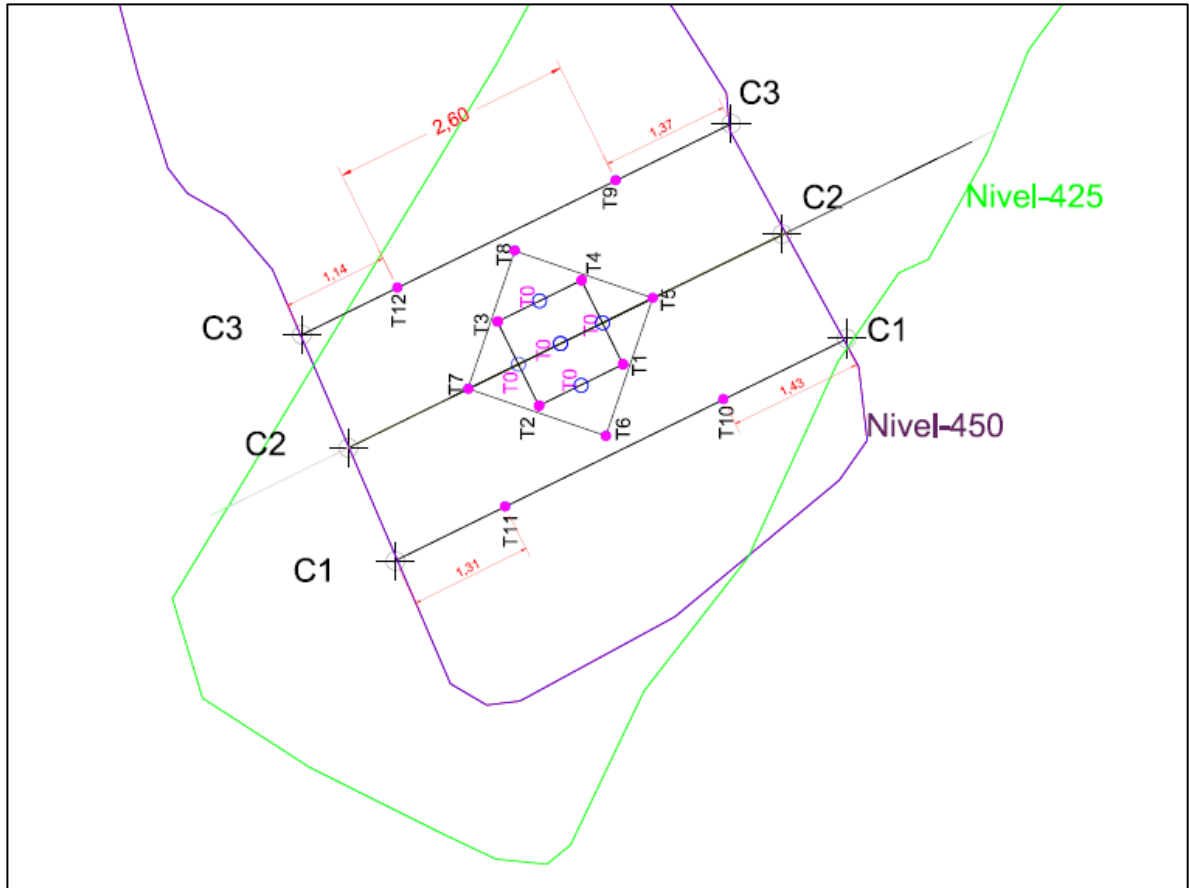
Vista en planta de las marcas y diseño de la chimenea
